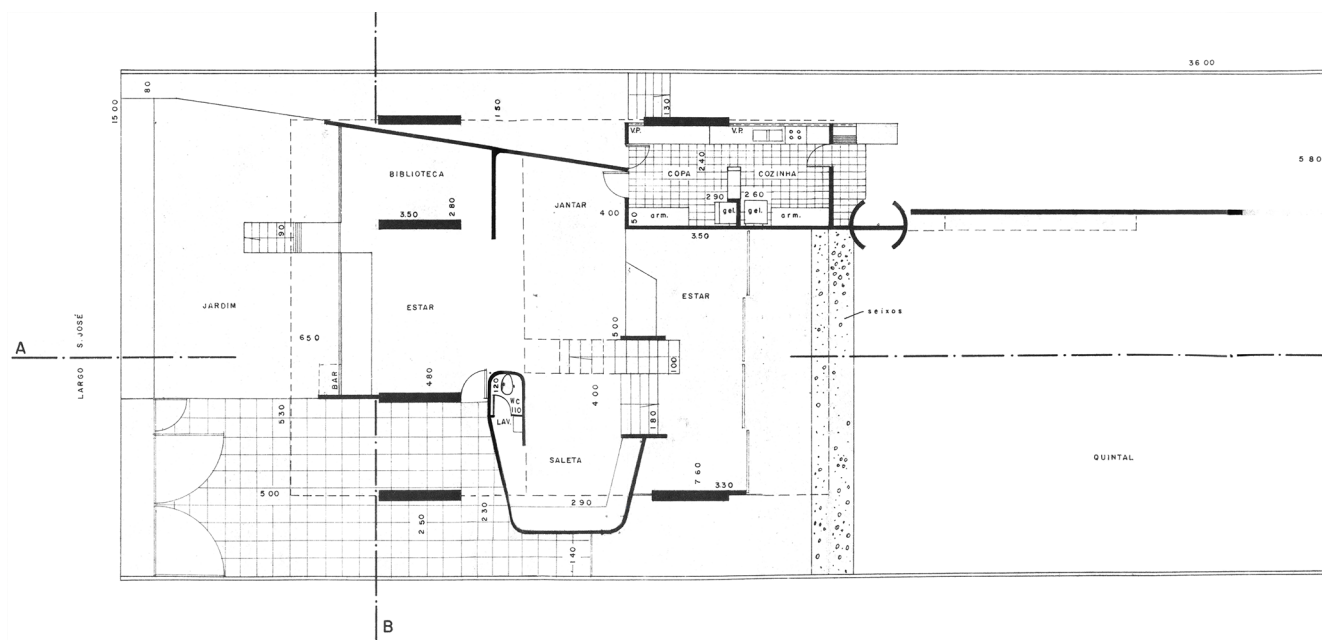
Planta baixa pavimento térreo. Fonte: Acervo Jorge Caron.
